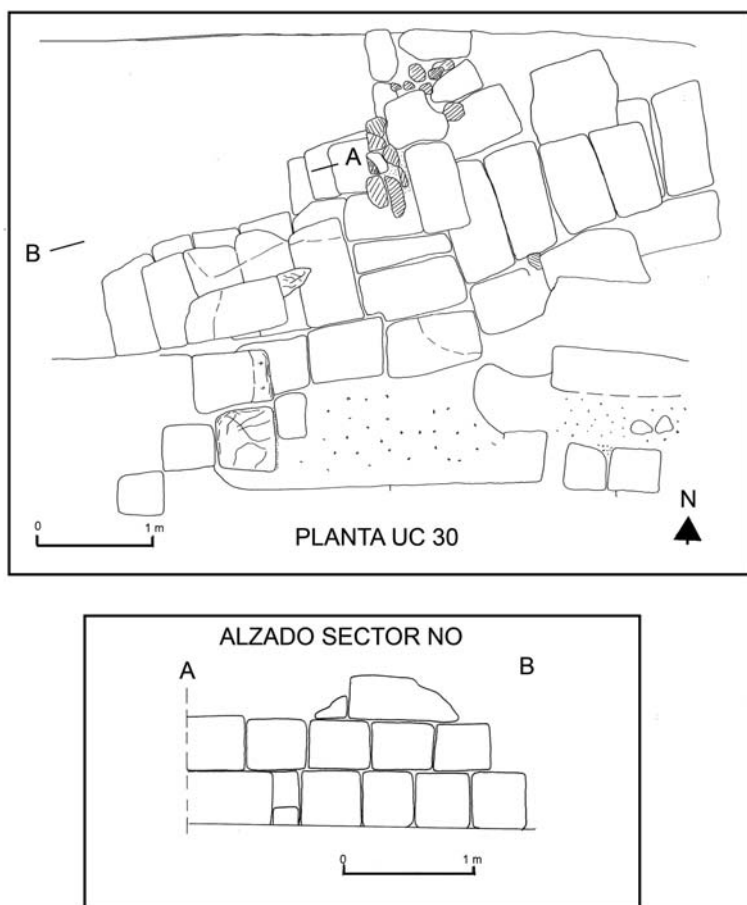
Planimetría y alzado de la unidad constructiva 30.
